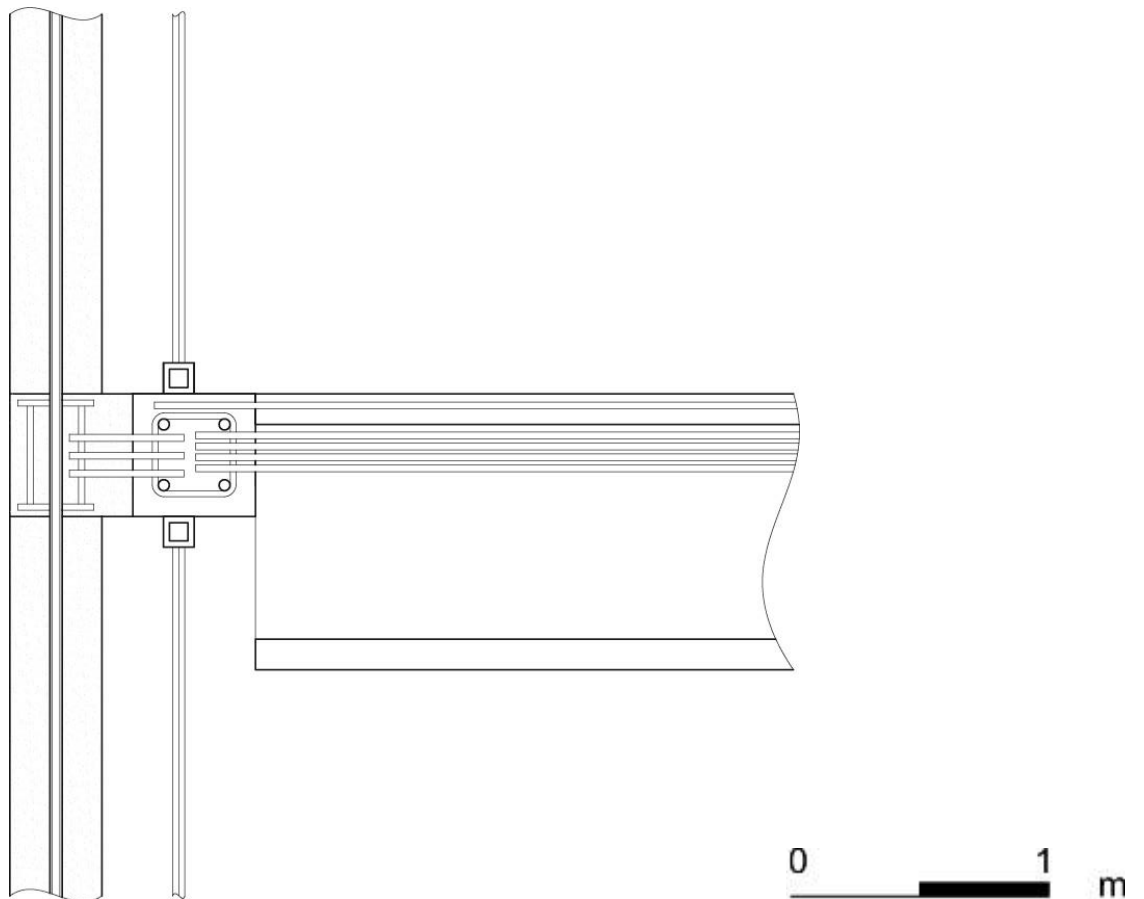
Sección constructiva de la unión del forjado con el pilar y detalle del cable de postesado en la columna. Escala 1/50.
